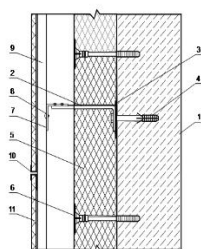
Схема конструкции наружной стены с вентфасадом
